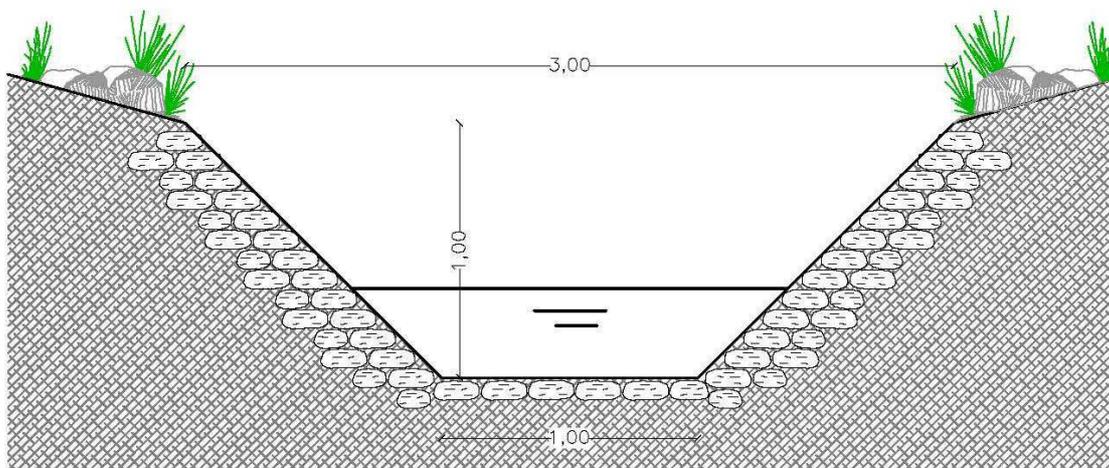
sezione trasversale del canale di guardia rivestito in pietra per l'affluente Sud
